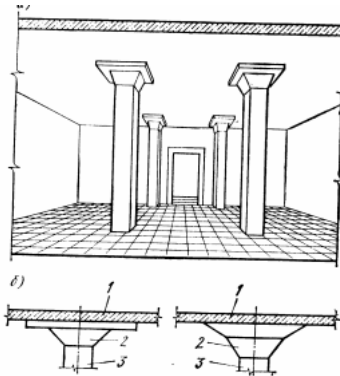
Залізобетонне монолітне безбалкове перекриття:
